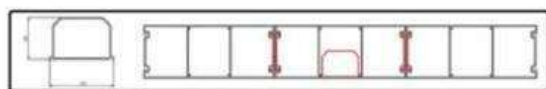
Esquema em planta do perfil canaleta dentro do módulo básico
